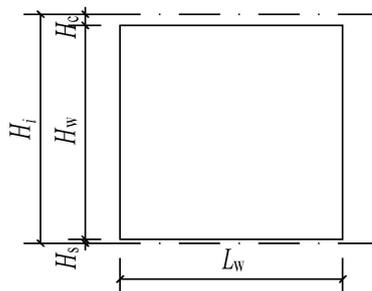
无洞口混凝土外墙编号规则示意图
